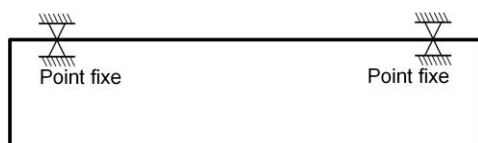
Disposition des points fixes pour des tubes médians en plastique avant coude ou changement de direction.
